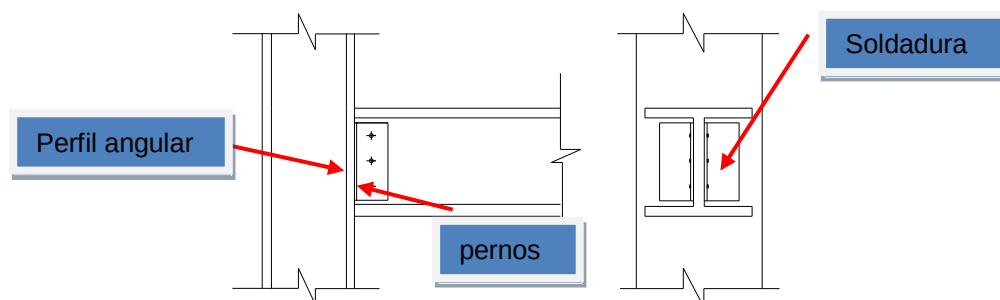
Dibujo de conexión tipo de la estructura Noroeste 3
